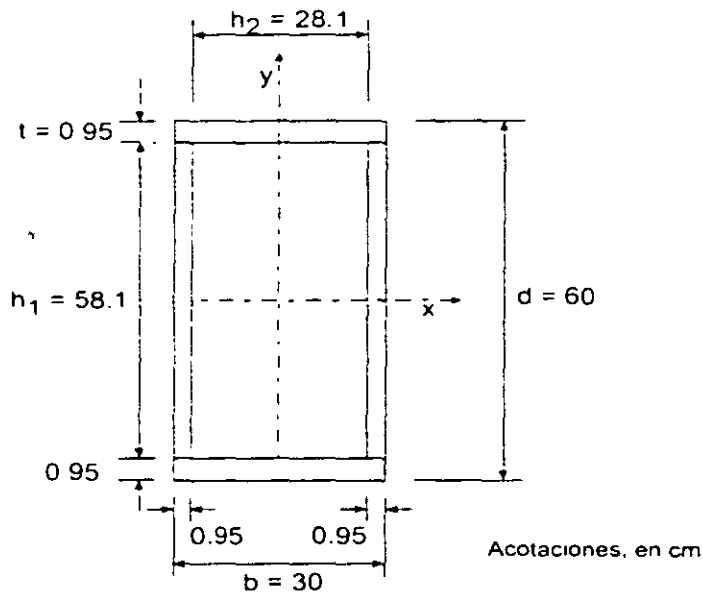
Sección transversal de la columna del ejemplo 2.5.
